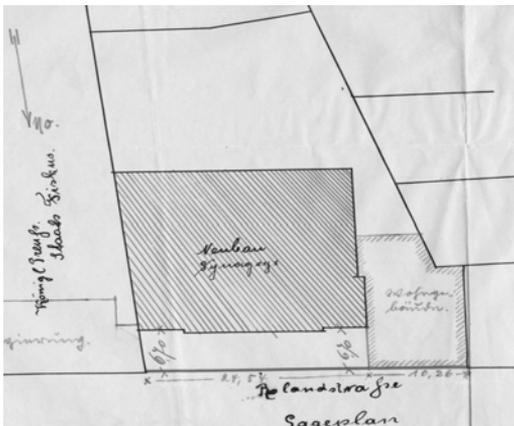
Lageplan 1906, Gesuch der Einfriedung
